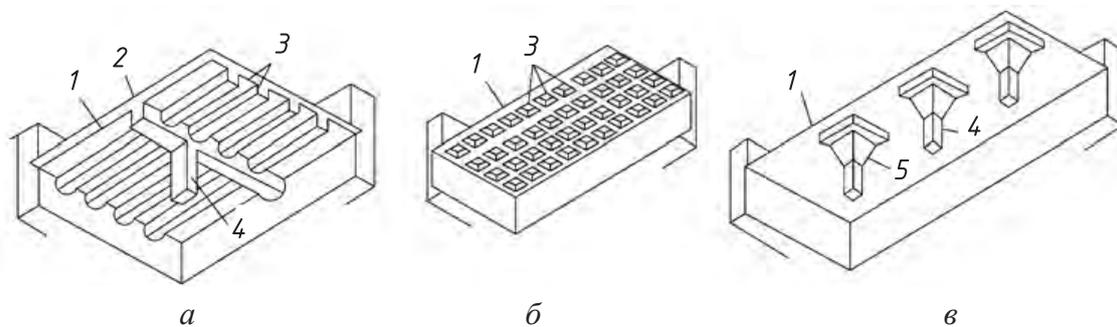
Типы междуэтажных монолитных перекрытий: *а* — ребристое; *б* — кессонированное; *в* — безбалочное: 1 — плита; 2 — главная балка (ригель); 3 — второстепенная балка; 4 — колонна; 5 — капитель
